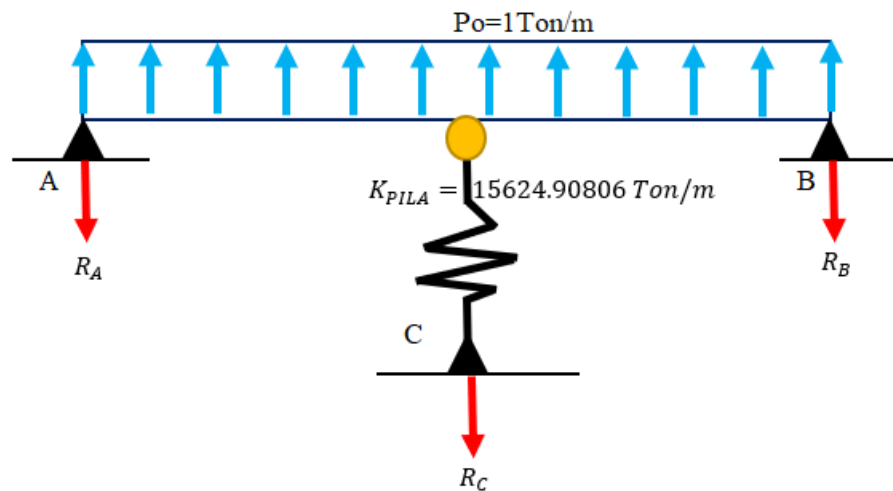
desplazamiento transversal-FUENTE: ELABORACION PROPIA
